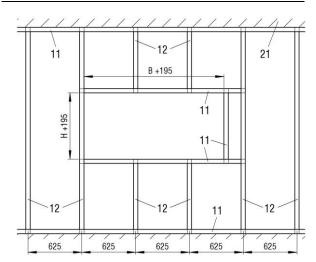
Metallständerwerk mit erforderlichen Auswechslungen (für BKA-EN mit Einbaurahmen ER, Wanddicke > 100mm)
